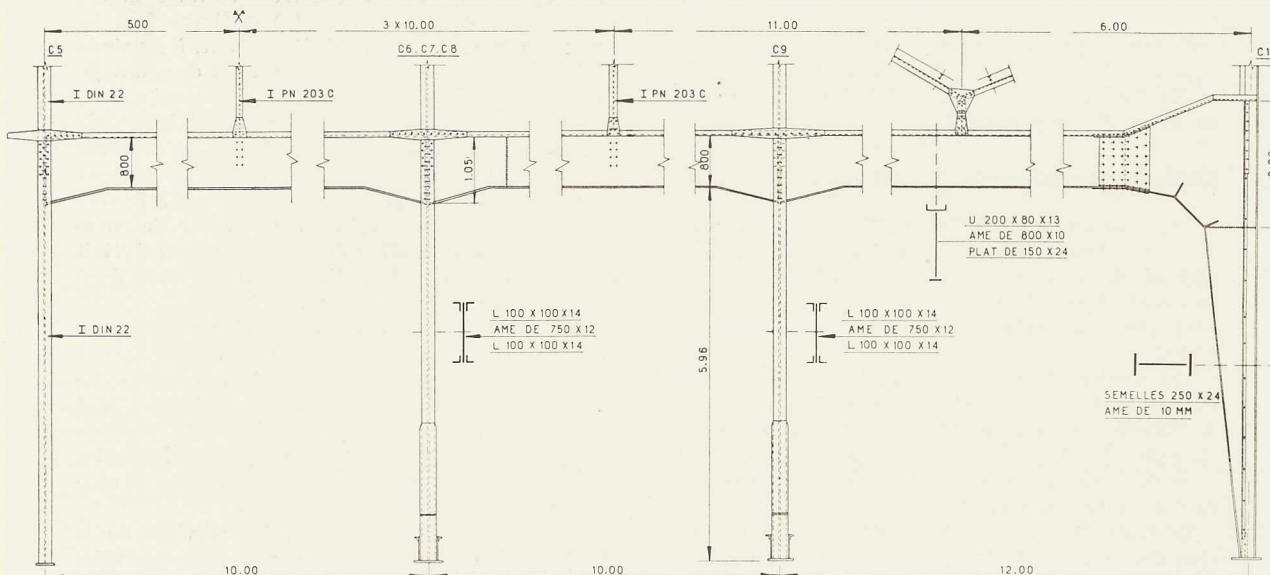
Coupe dans le portique supportant la charpente du hall de 30 mètres (portique C₁ C₁₁).
